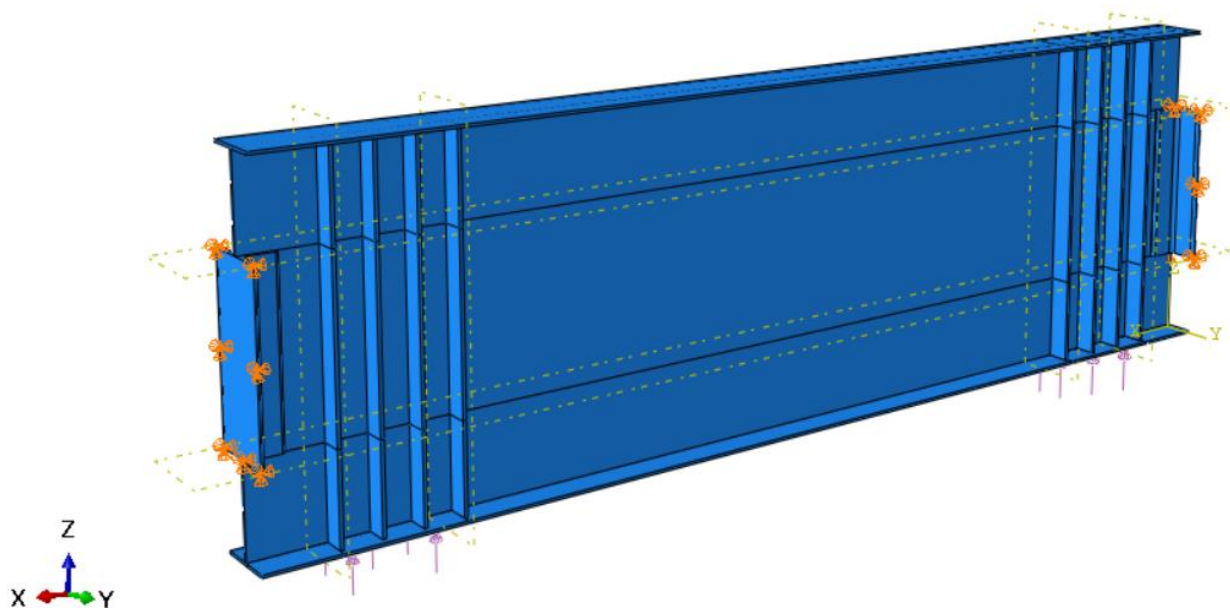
Detalhe da Viga de Apoio com Chapas de Travamento Vertical
